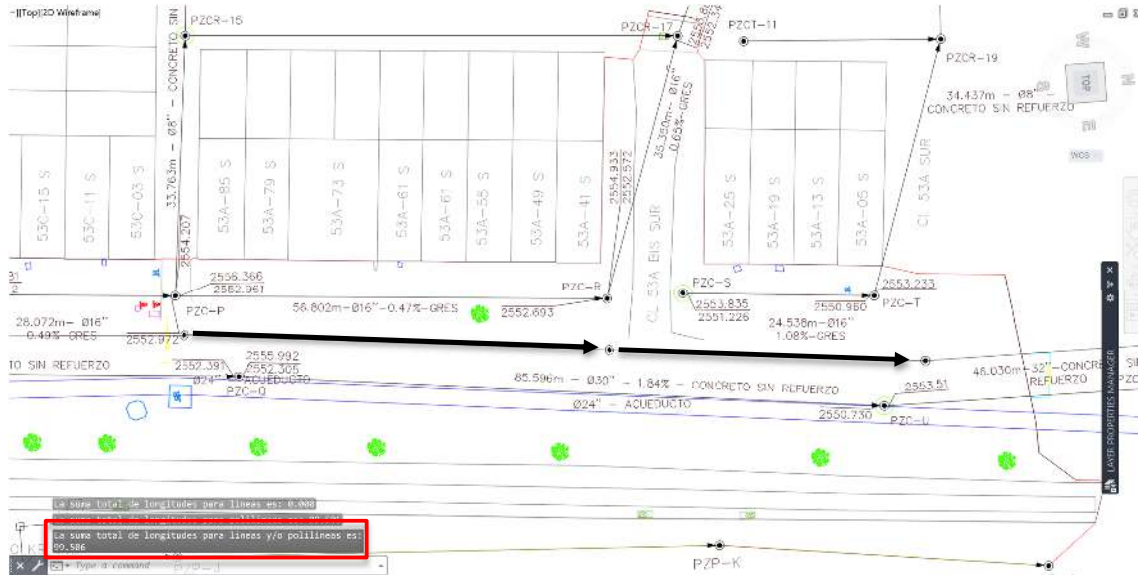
Cuantificación de longitud alcantarillado pluvial D 33".
